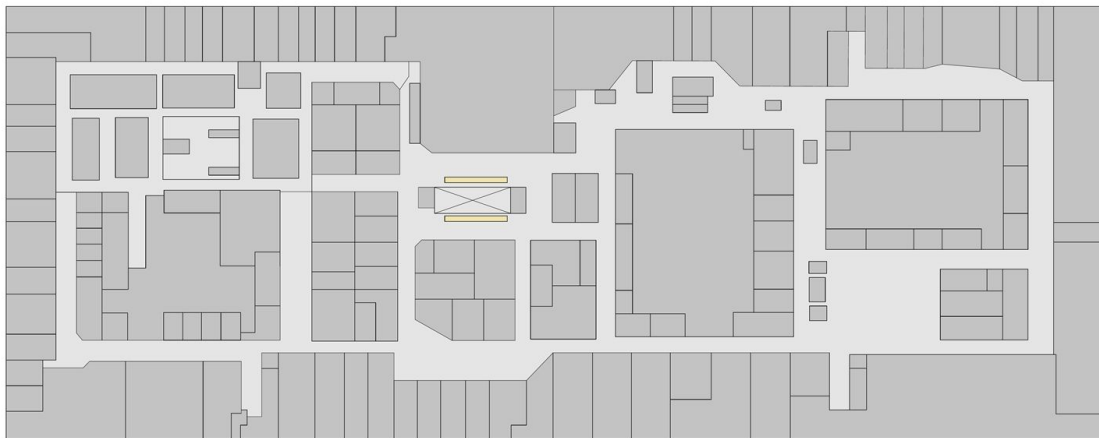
Planta baixa do 2º pavimento do Conjunto Nacional. Fonte: SOBRAL, 2020.
